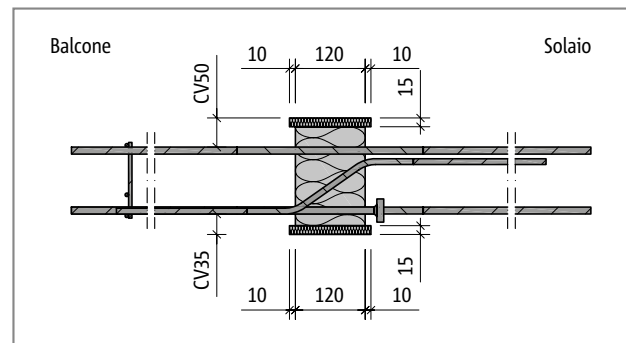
Schöck Isokorb® tipo EXT30-CV50, REI120: sezione dell'elemento
